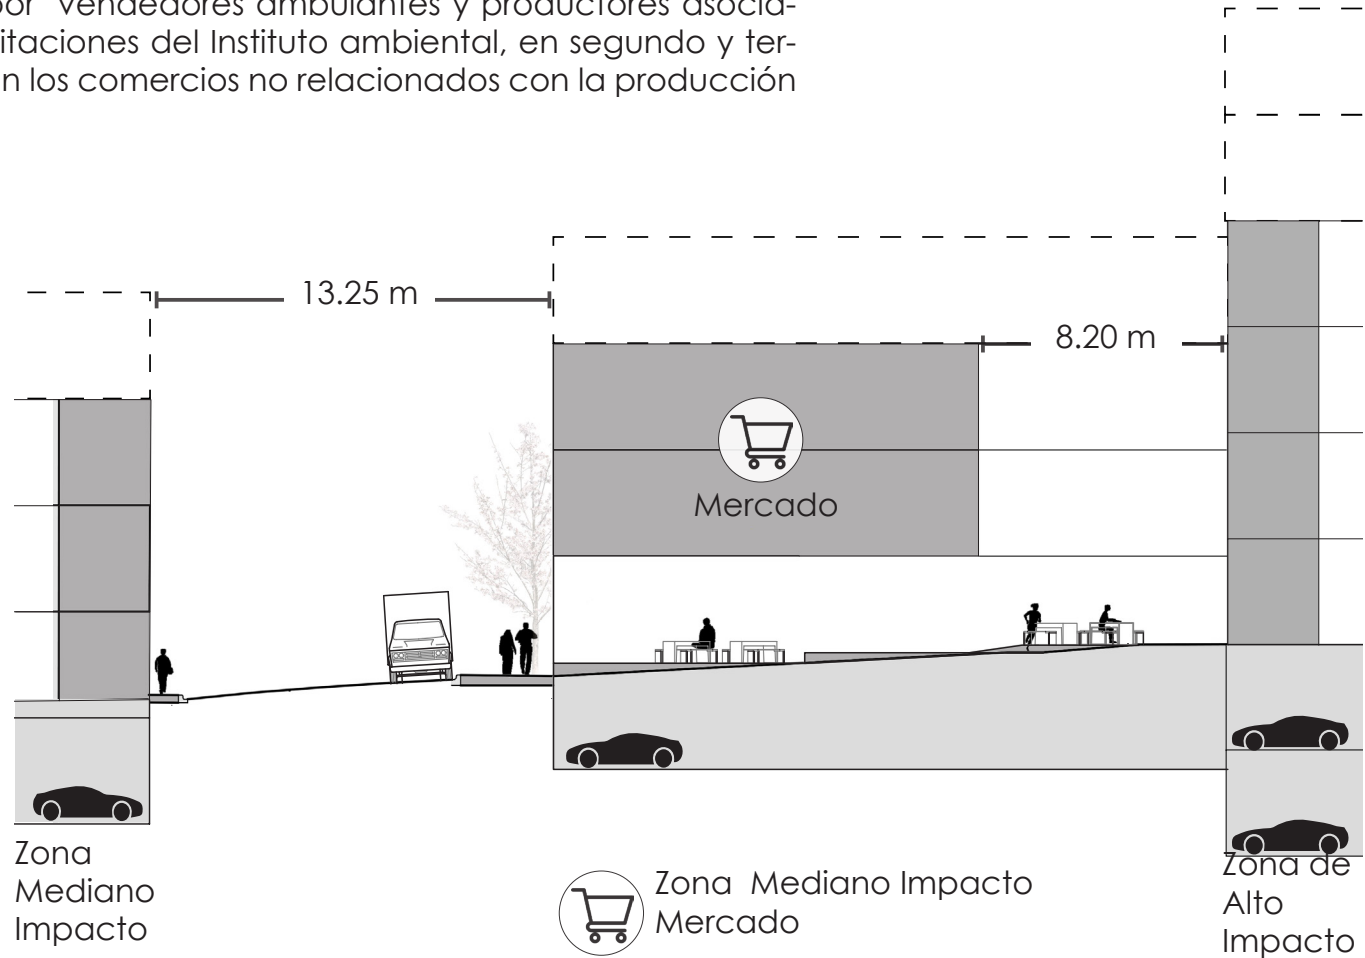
Corte B-B :Mercado de Barrio Pinto
